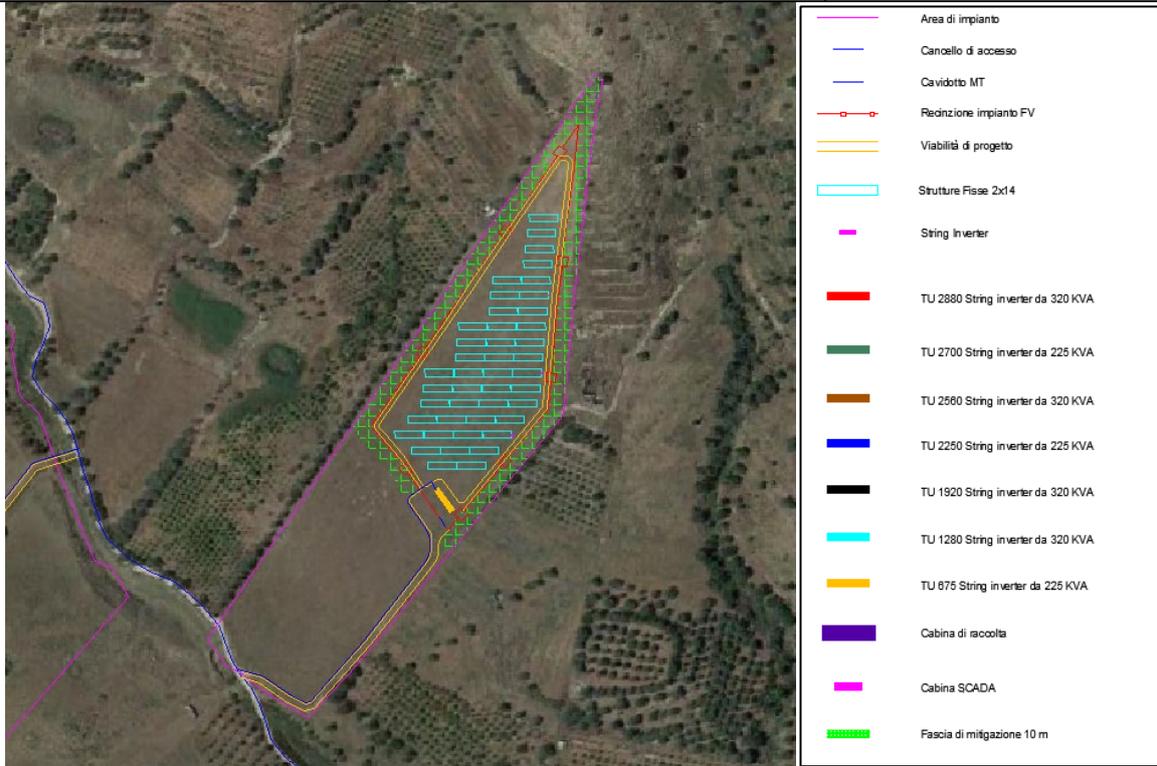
Sovrapposizione su ortofoto del layout di impianto – Lotto 5
